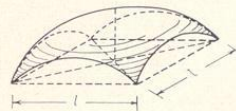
Schirmgewölbe über der Wandelhalle der Landeskuranstalt Bad Hall.
